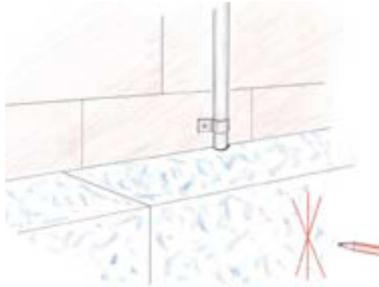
Detalle de la instalación de las planchas de aislamiento en la fachada cuando existen conducciones externas.
